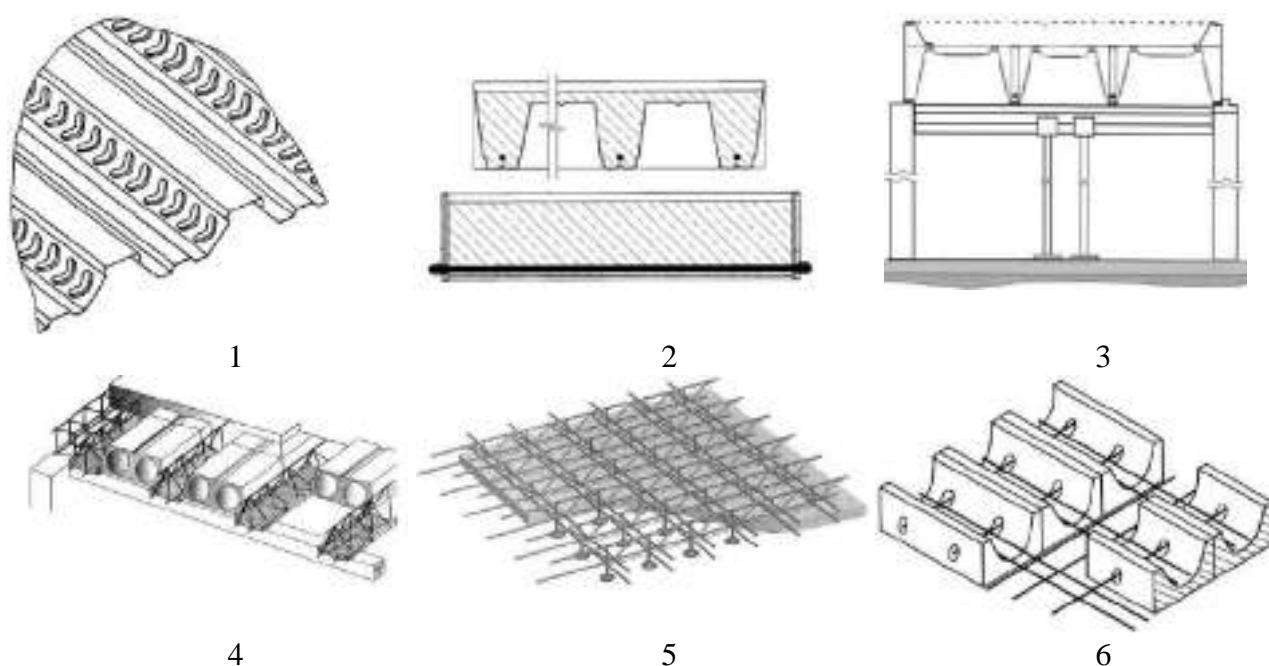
Несъемная опалубка перекрытий: №1 Гордилов О.Г. «Несъемная панельная опалубка монолитного перекрытия», №2 Шестопалов Е.Г. «Монолитное перекрытие», №3 Анпилов С.М. Несъемная опалубка, №4 Опалубка «Марко», №5 Павлов В.В. Подвесная несъемная опалубка, №6 Рахманов В.А. Сборно-монолитное перекрытие.
